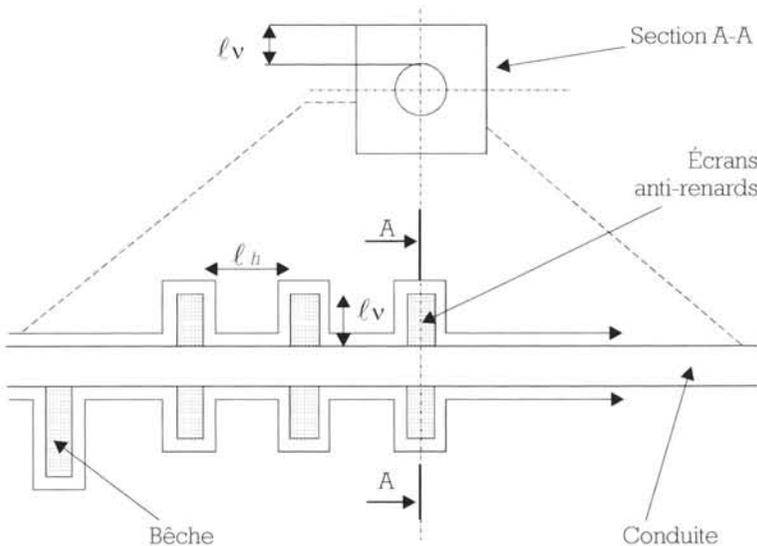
Allongement des lignes de fuites le long d'une conduite par écrans anti-renards (1 m).
